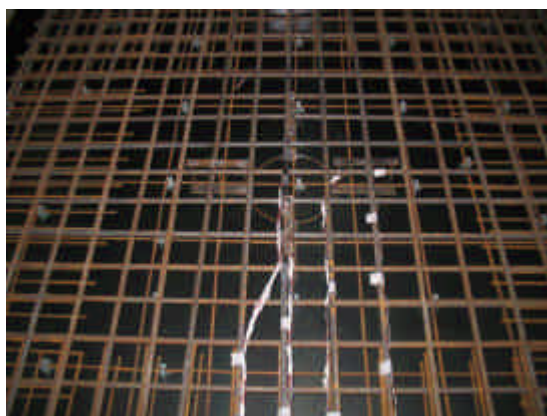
Distribuição da armadura de cisalhamento para laje com pilar quadrado
